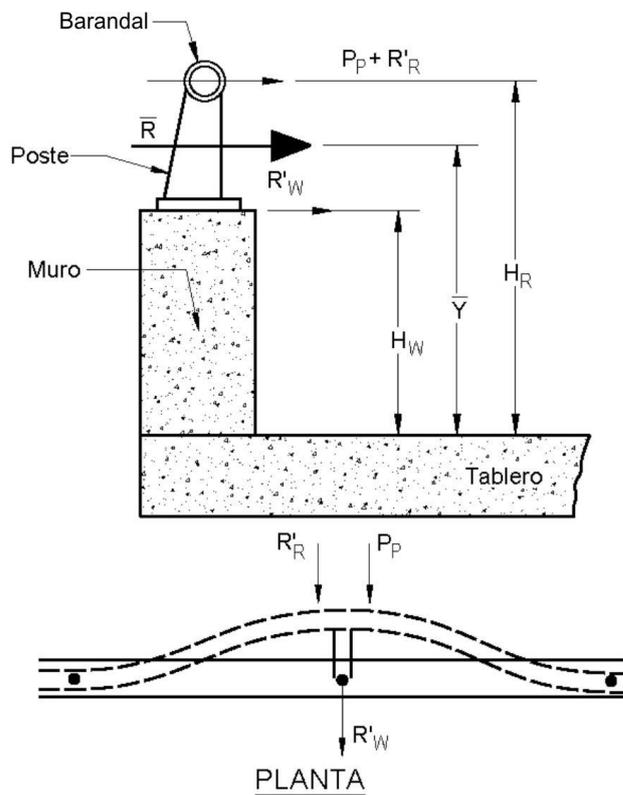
Evaluación del conjunto formado por un muro de hormigón y postes y barandales metálicos – Impacto en un poste
